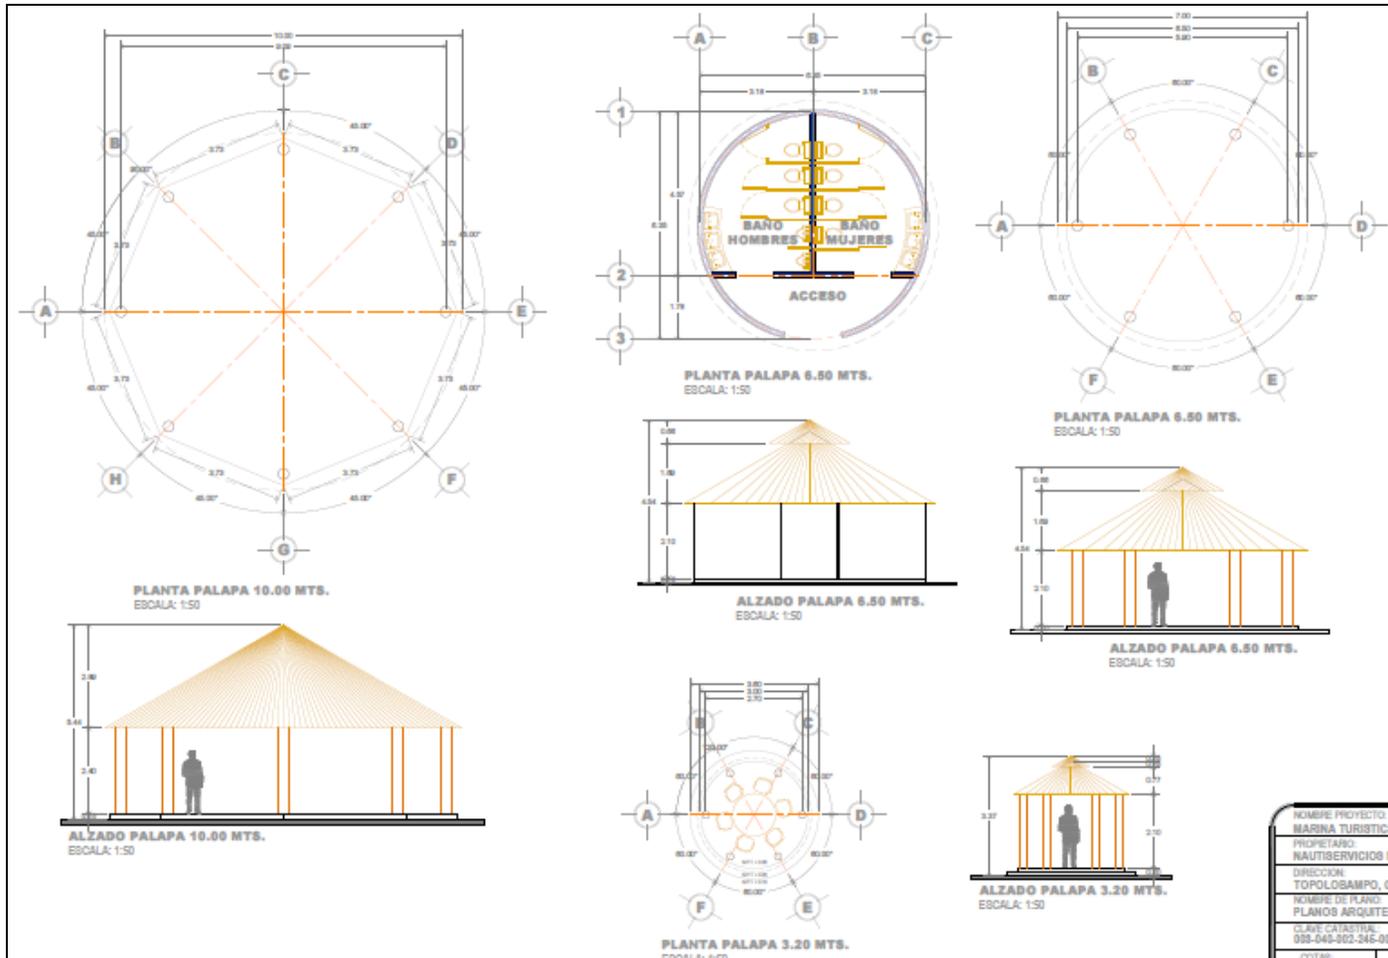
Palapa. Ver detalles en Plano Arquitectónico A-04.
